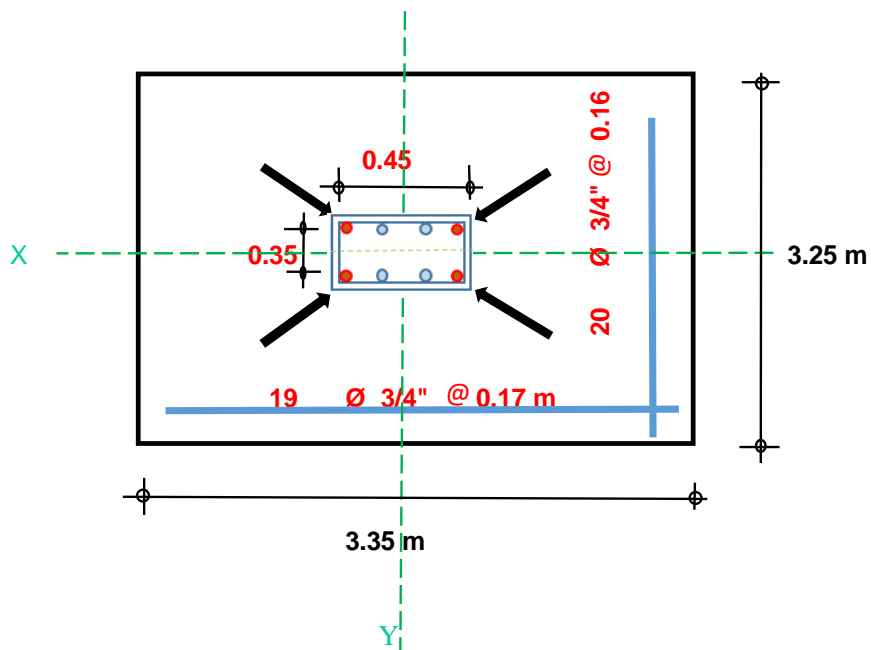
Detalle de planta de la zapata central (Estructura 1).
